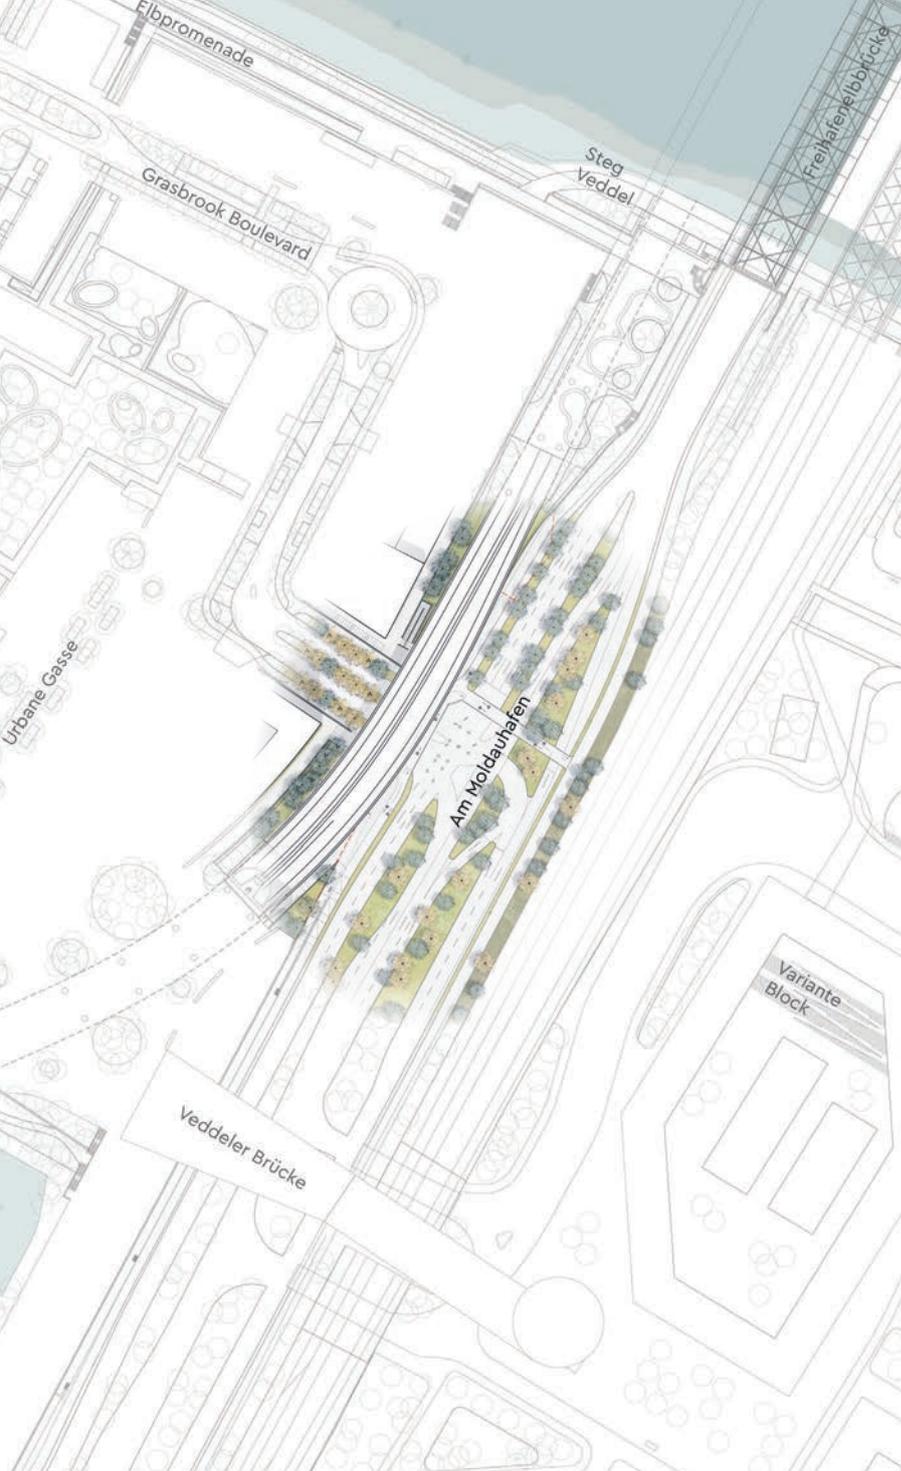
Lageplan Anschlussknoten Stadtteileingang/ Am Moldauhafen
